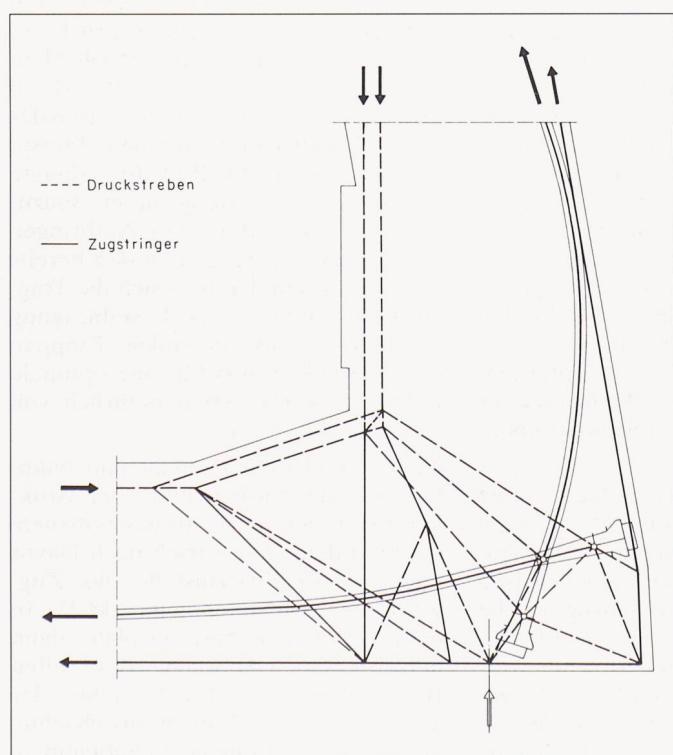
Fachwerkmodell der oberen <positiven> Rahmenecke mit Umlenkung der Druckstreben (Ing.büro H. Rigendinger)
